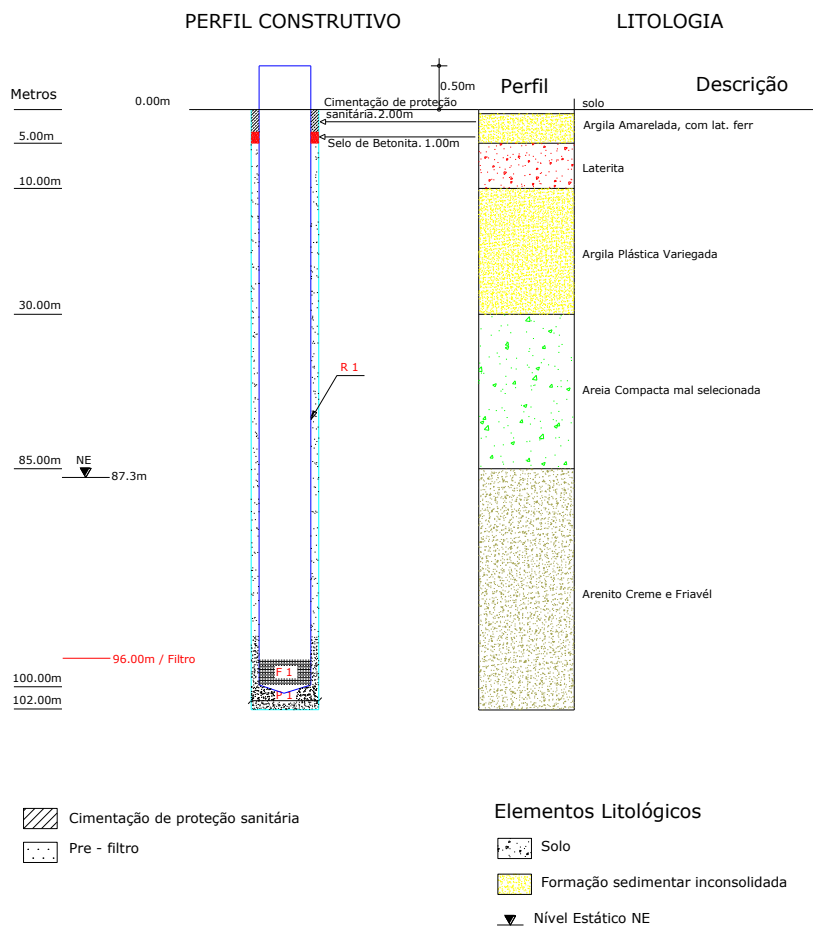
Perfil construtivo esquemático dos piezômetros profundos.
